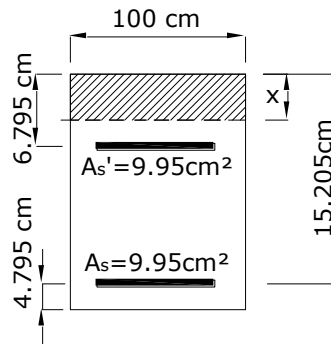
8-7 Sección fisurada para momento positivo
